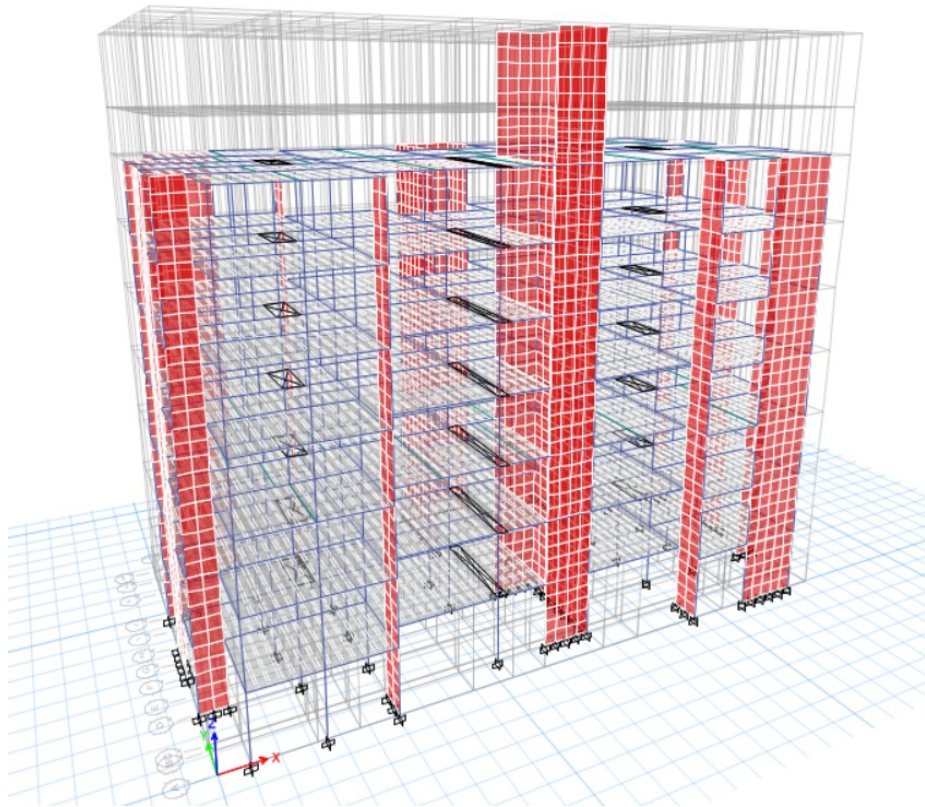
Disposición de elementos estructurales (Vista 3D) Sistema Dual - Edificio Blesser. Fuente: Elaboración Propia.
